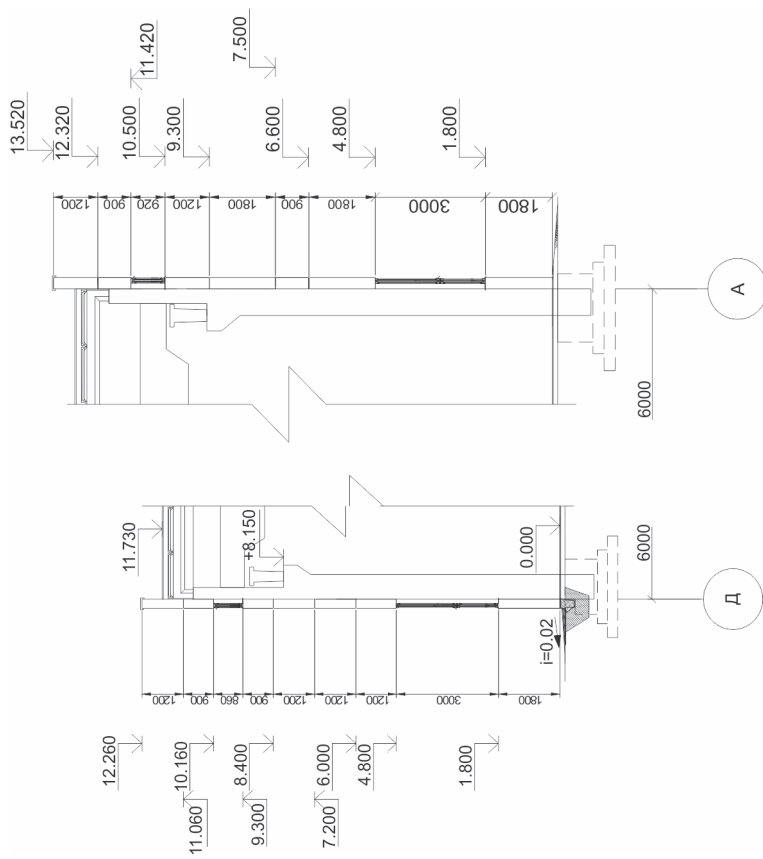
Расчетная схема определения монтажных горизонтов железобетонных элементов каркаса здания (выполнено А.А. Семиволковой, гр. ПГС-09-1)
